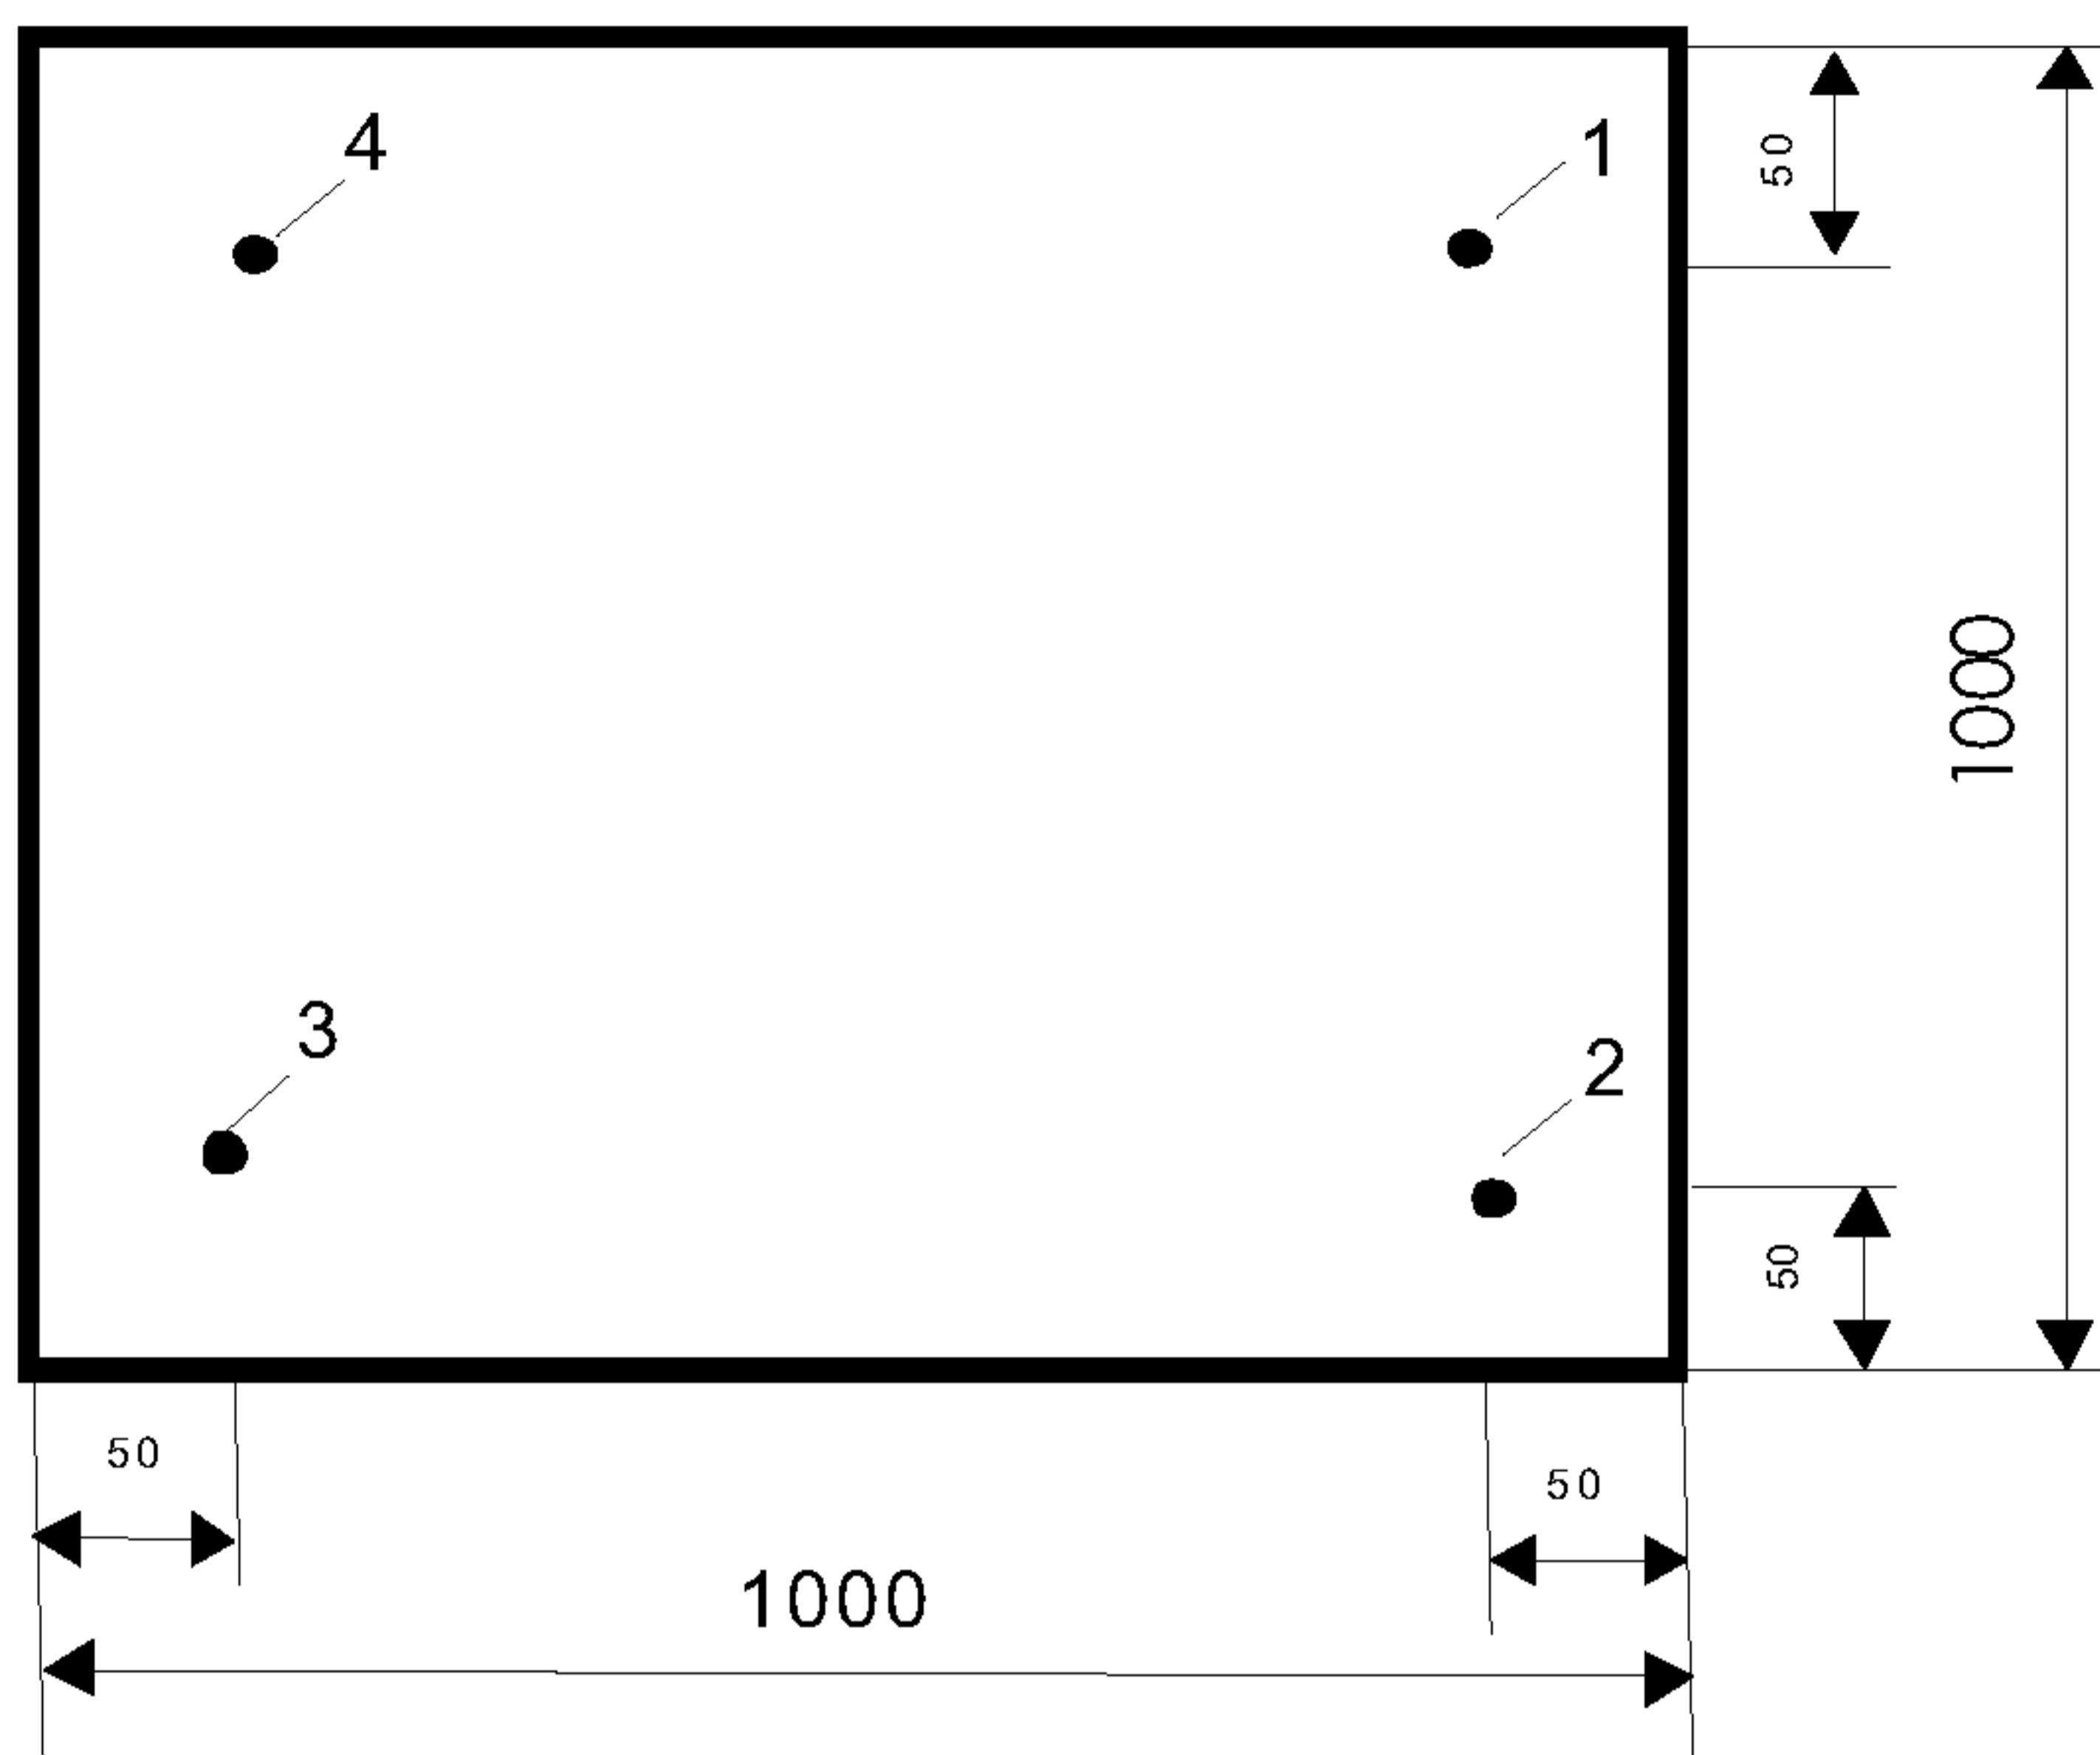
Схема размещения испытательных точек на опытном участке пола
